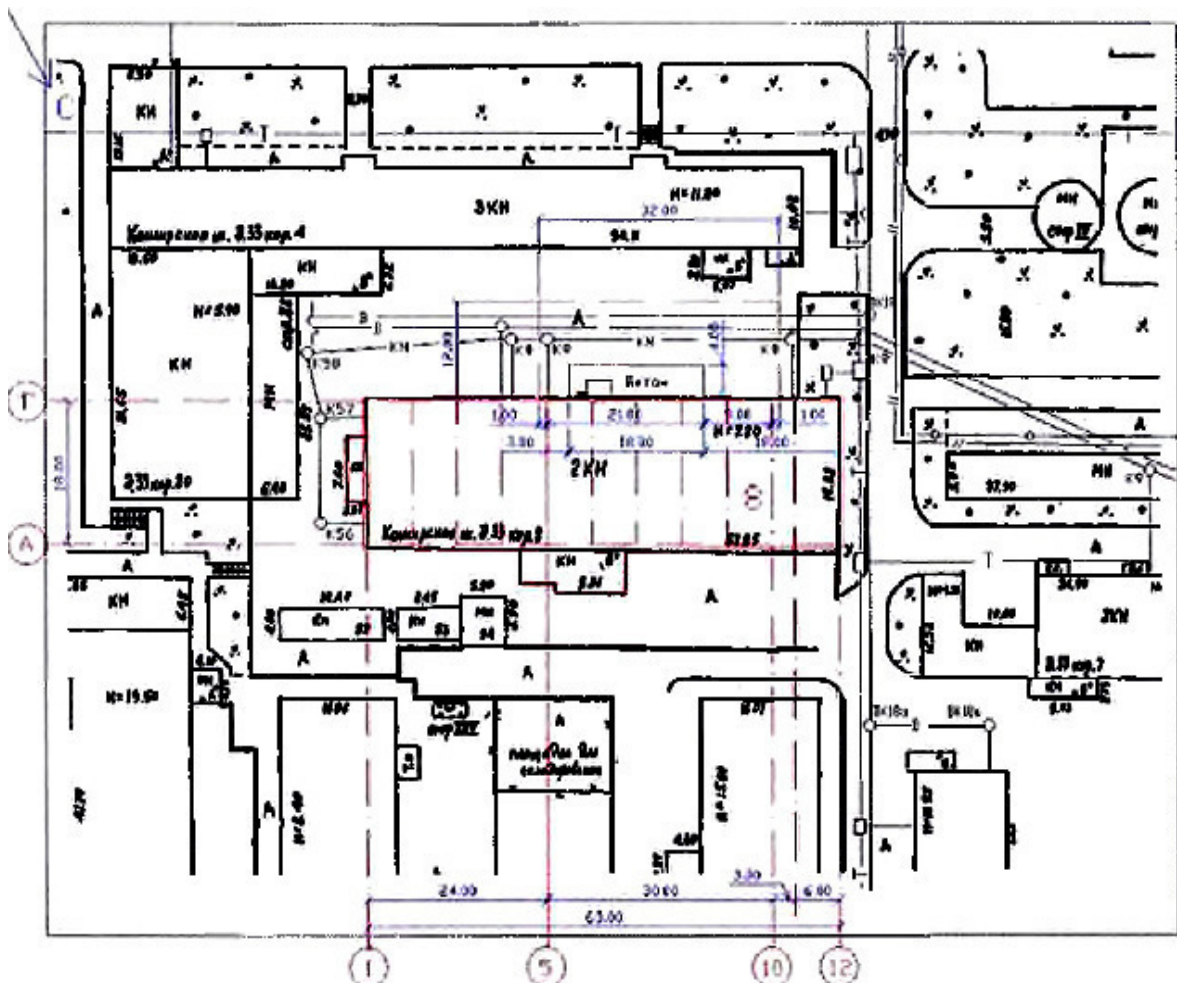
Схема генерального плана корпуса № 8
